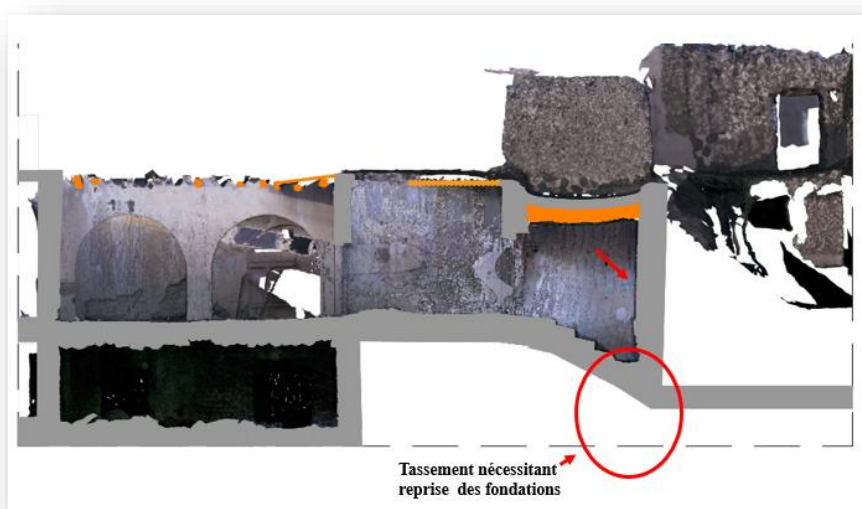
coupe B.B photo 3D texturée sur le caravansérail indiquant l'endroit de la reprise des fondations. Source : Auteure.2022.
